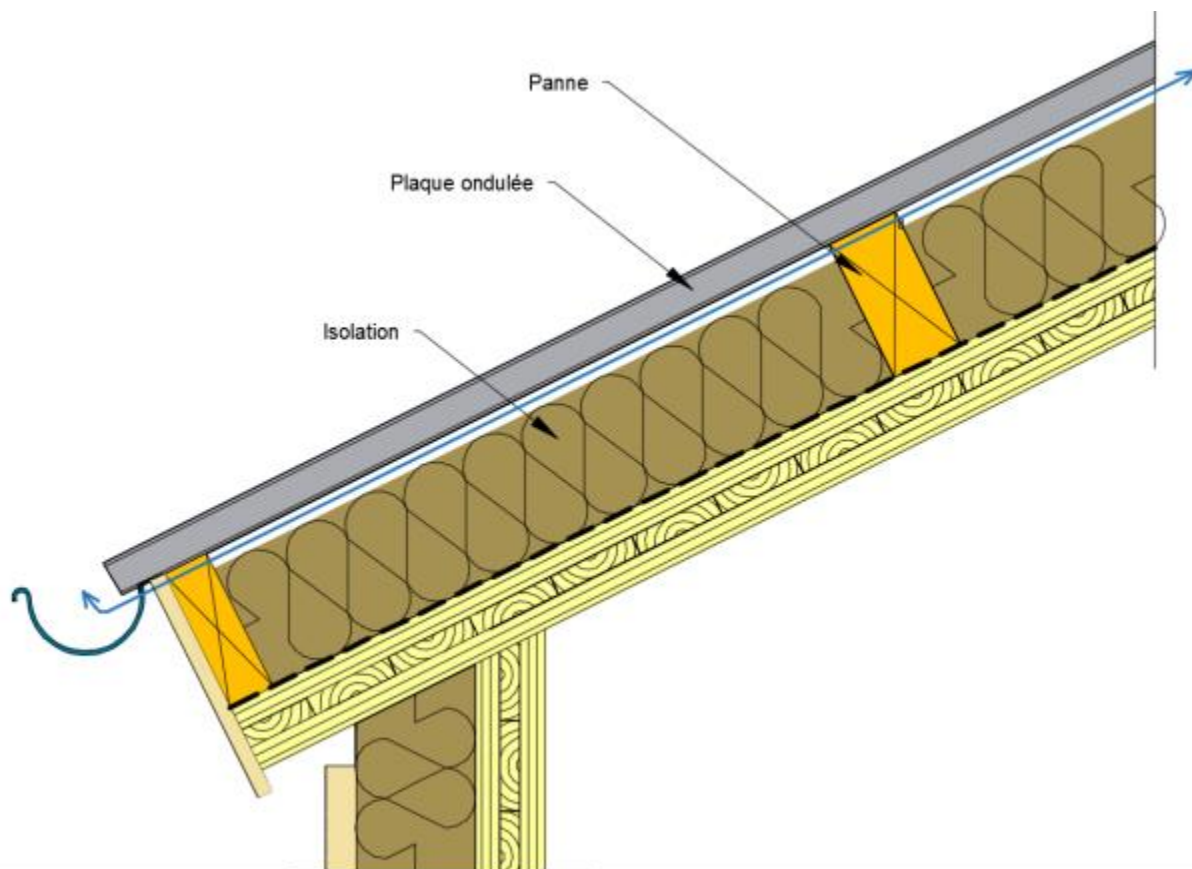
Traitement de l'égout avec panneau structural en débord - Couverture en plaques ondulées en fibres-ciment – Cas où la section des ondes des plaques est suffisante pour la ventilation en sous-face - Climat de plaine
